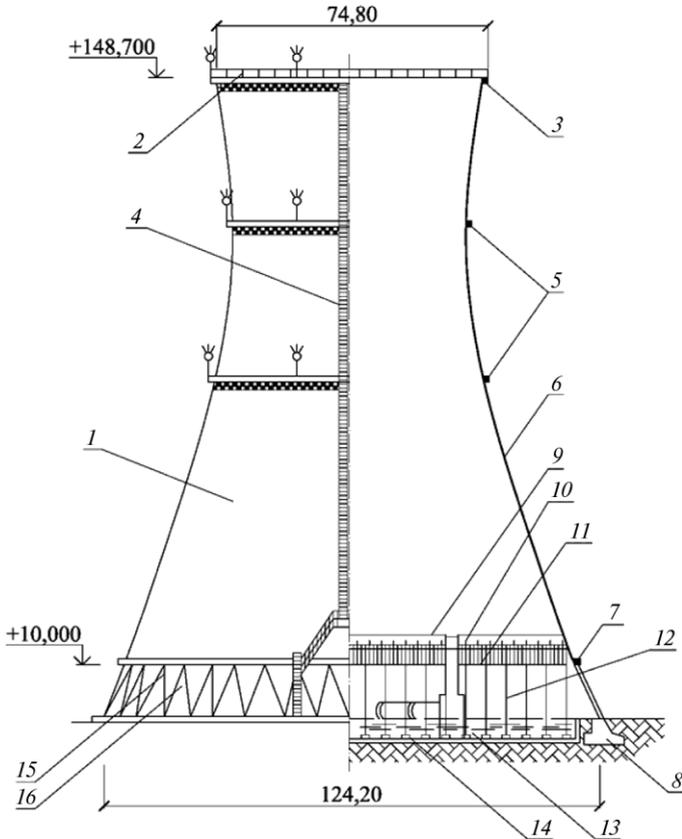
Схема башенной градирни: 1 — вытяжная башня; 2 — молниезащита; 3 — верхнее кольцо жесткости; 4 — лестница; 5 — кольцо жесткости; 6 — стенка оболочки; 7 — нижнее опорное кольцо; 8 — фундамент башни; 9 — водоуловитель; 10 — водораспределительное устройство; 11 — ороситель; 12 — каркас оросителя; 13 — водосборный бассейн; 14 — днище бассейна; 15 — опорная колоннада; 16 — воздухоходные окна
